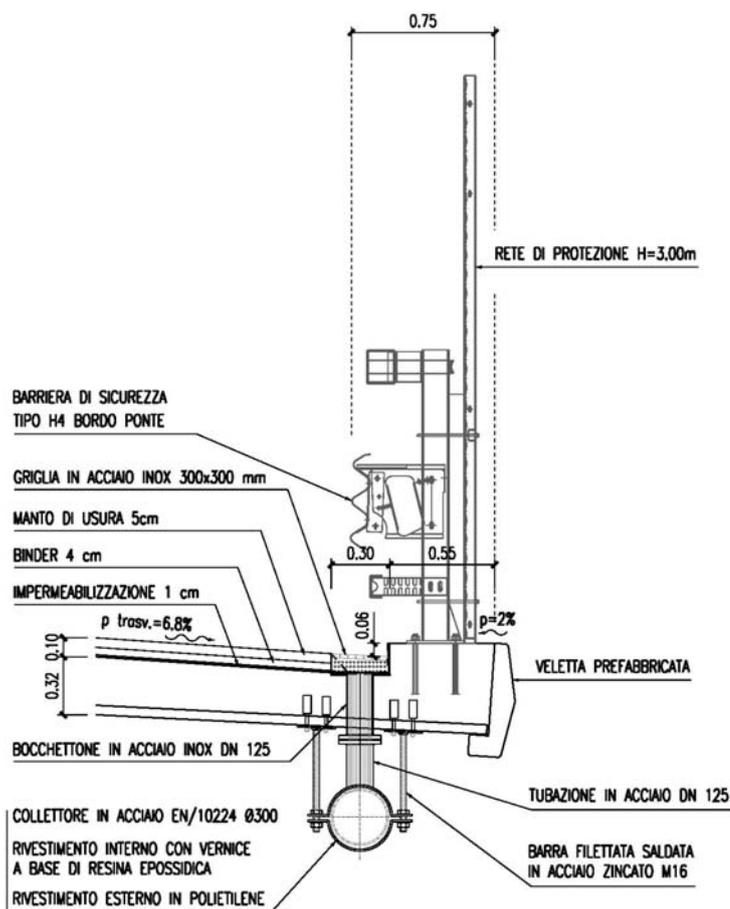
Particolare sistema di drenaggio in viadotto
